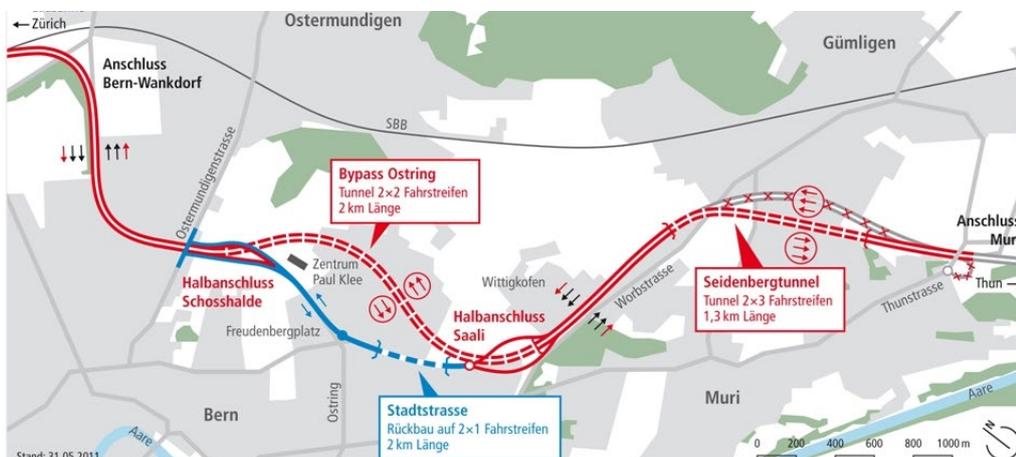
Schemaplan mit Seidenbergtunnel und Bypass Ostring ("Variante B5", Quelle ASTRA)
